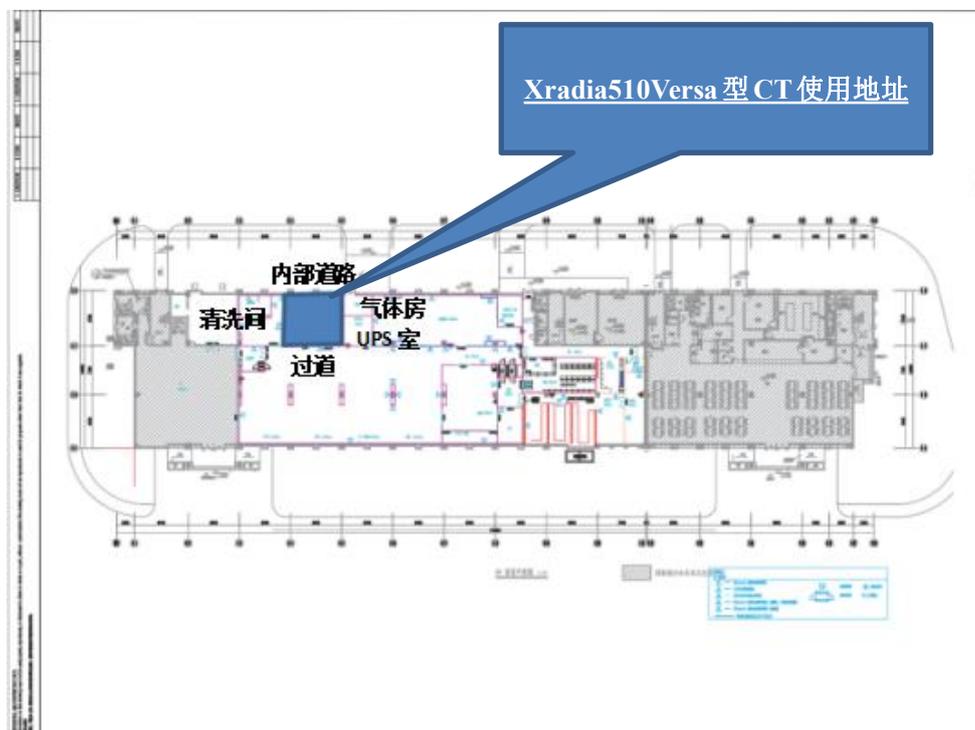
8 号楼一楼 104 (A) X 光分析实验室四至图及平面布置图
